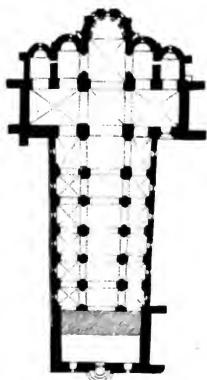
Grundriss der Kirche von Payerne.
